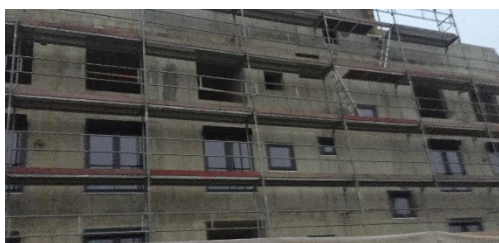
Priprava plošče za betoniranje strehe in priprava za izvedbo atike - dejansko stanje
